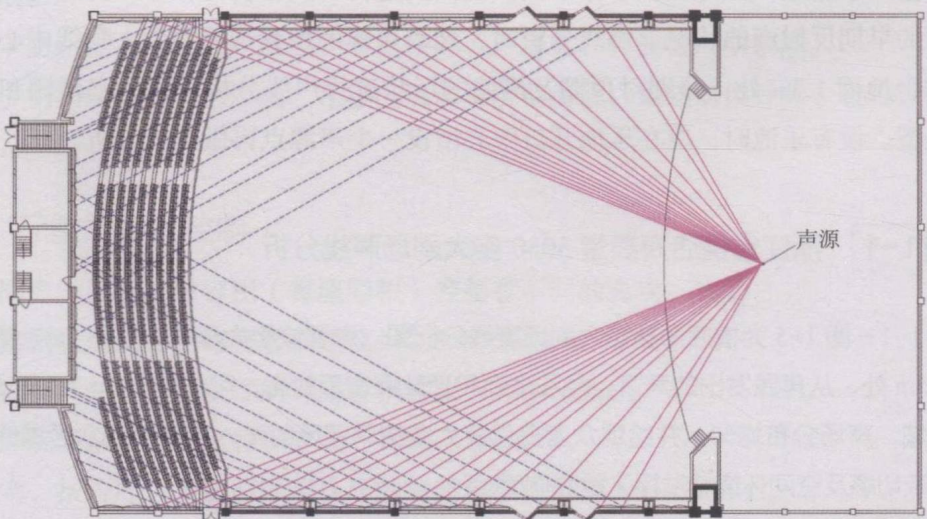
横店海晏堂大剧场楼座声线分析平面图
